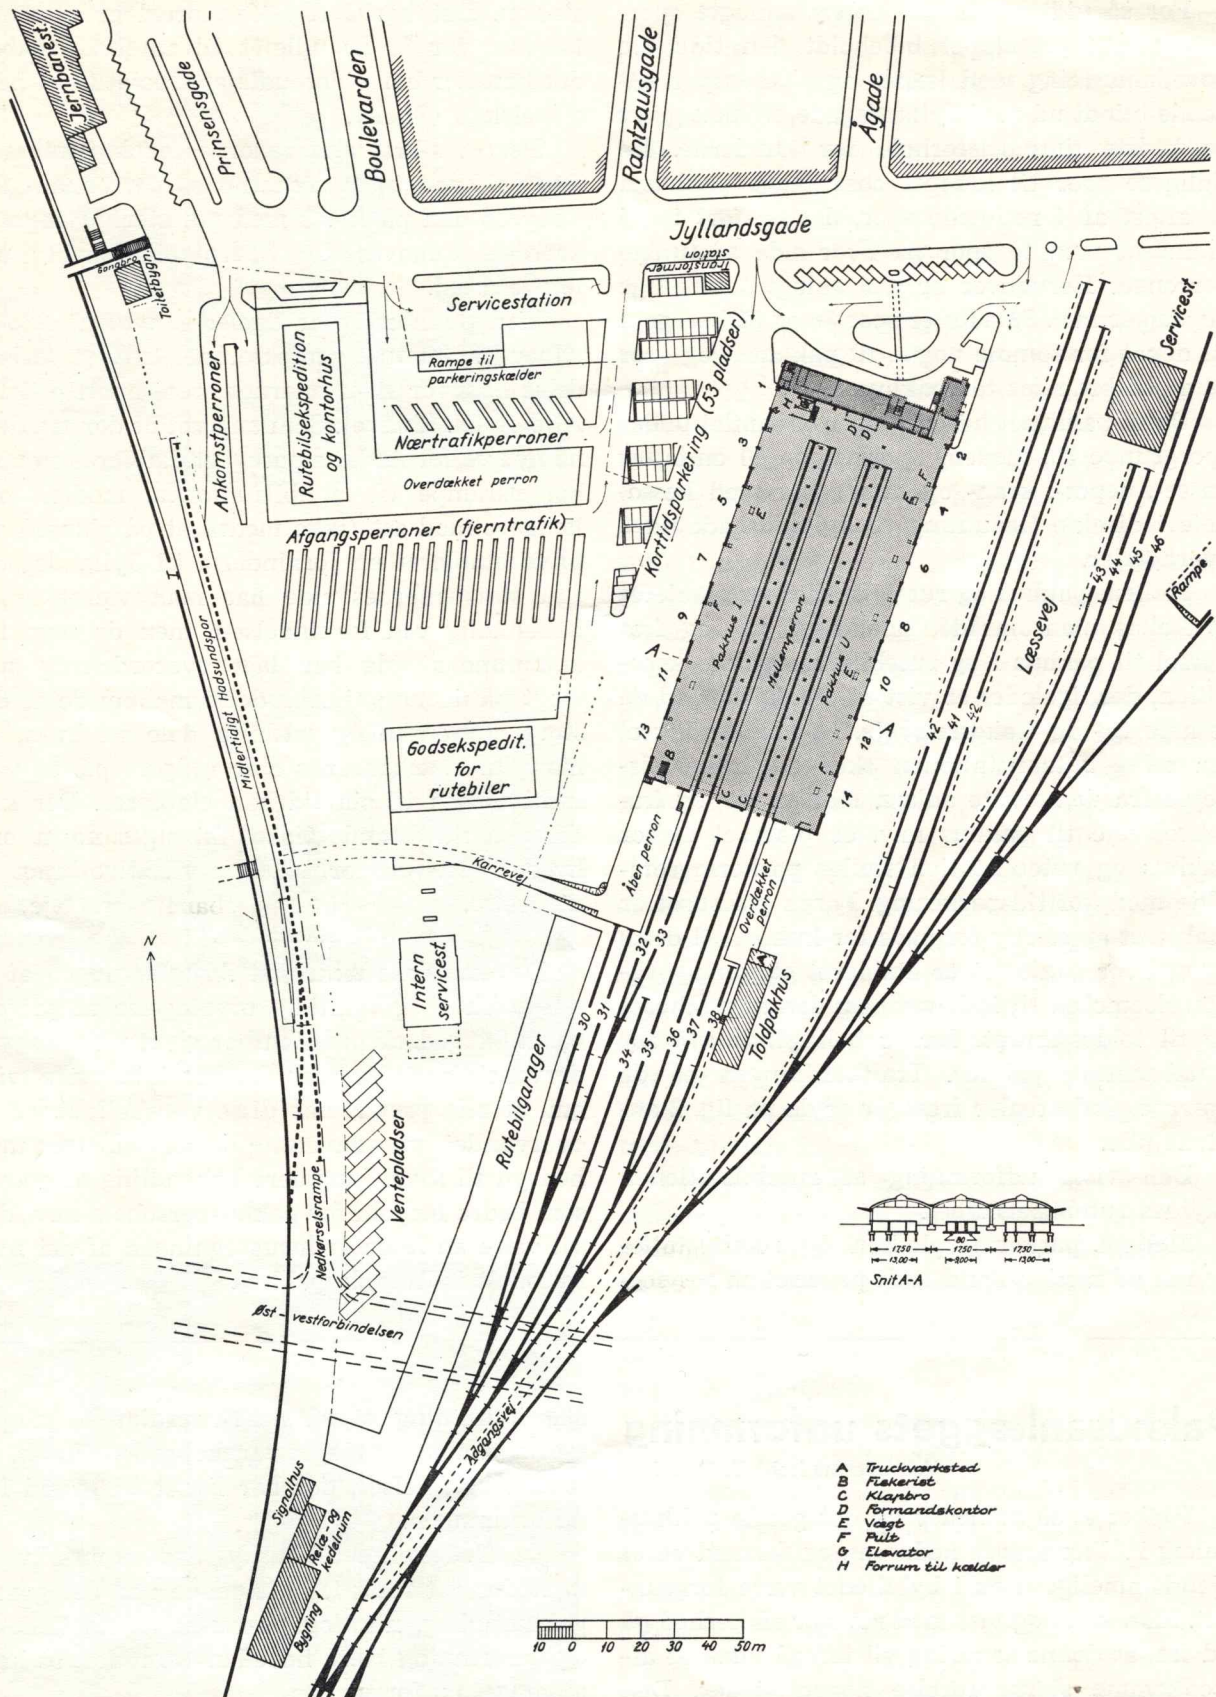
Oversigtsplan over det nye pakhhus med tilhørende spor- og vejanlæg m.v. samt den kommende nye rutebilstation vest for pakhuset. Af planen fremgår den nære tilknytning, der til sin tid vil blive opnået mellem jernbane- og rutebilstationen. På planen er endvidere vist et tværsnit gennem pakhuset, hvoraf hovedinddelingen af dette fremgår.
